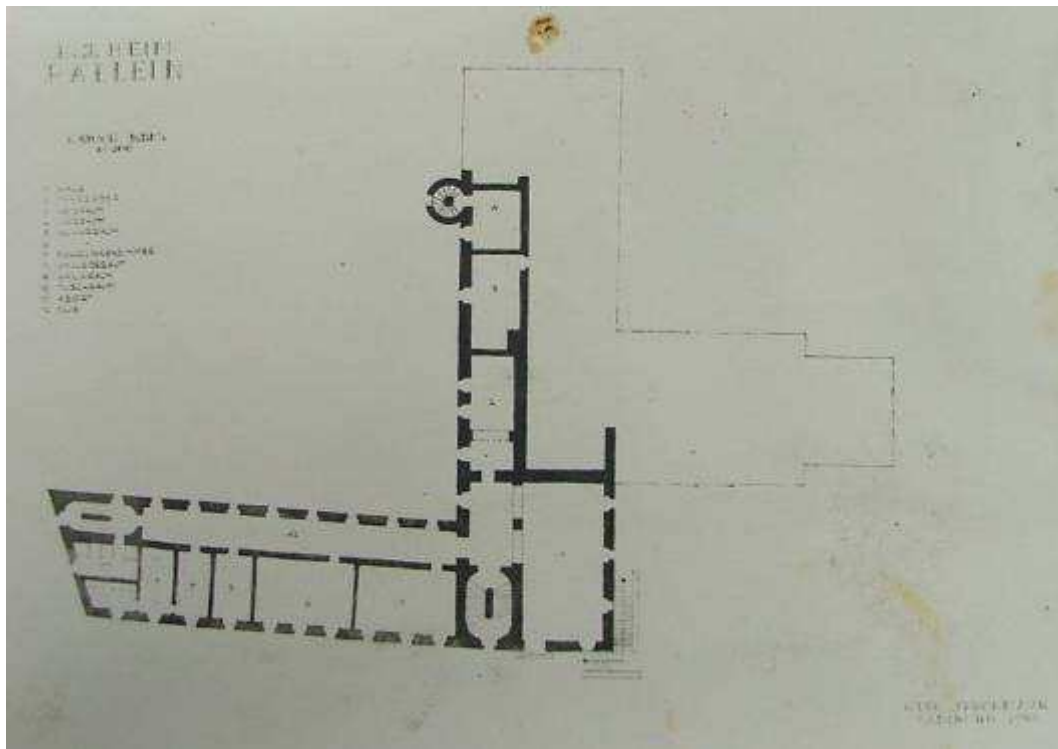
Otto Strohmayr, Grundriss, *1. Stock B. D. M., H. J. Heim Hallein*, 1943 (HSS, INR 4.564, 4.568, 4.569, 4.570, 4.571).
